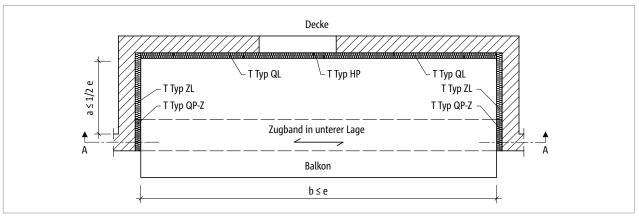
Schöck Isokorb® T Typ QP-Z, QL: Grundriss Loggia
